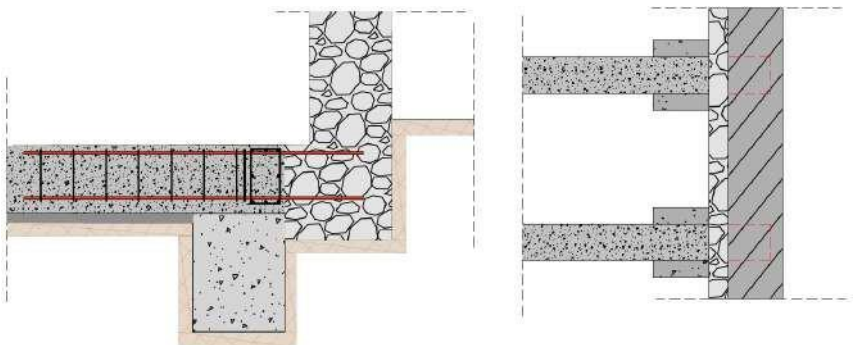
Sección zapata corrida. Refuerzo Tipo 3. Fuente propia
